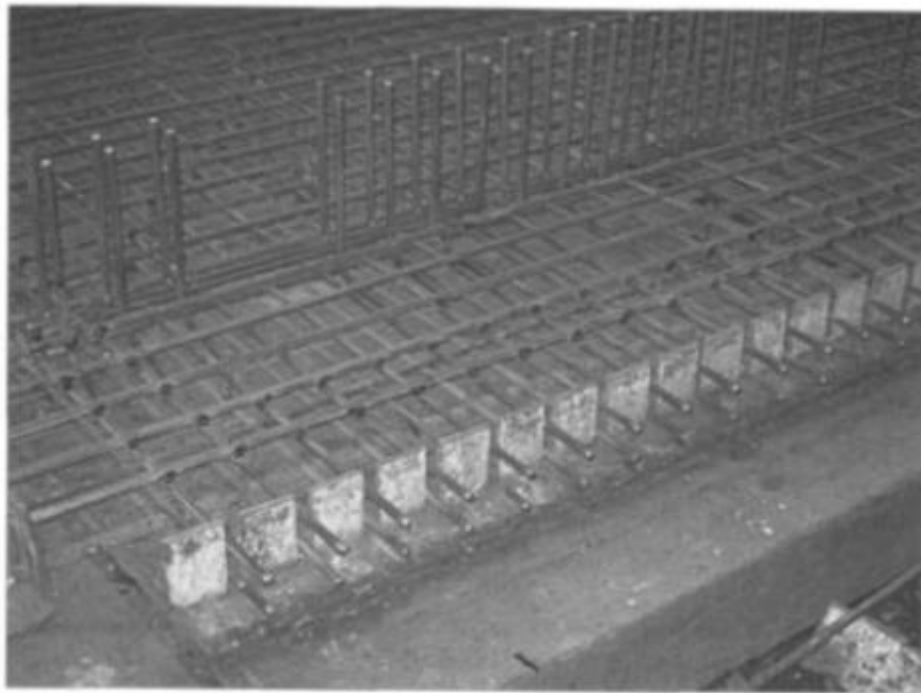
Стенд для виготовлення зварених арматурних каркасів залізобетонних секцій понтона дока.
